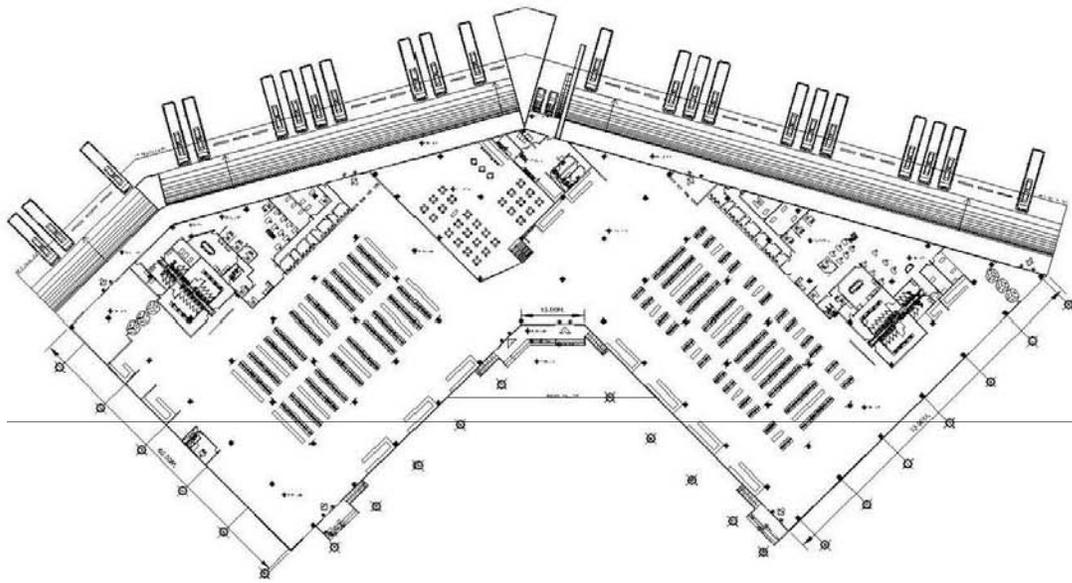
DISEÑO PLANO ARQUITECTÓNICO
